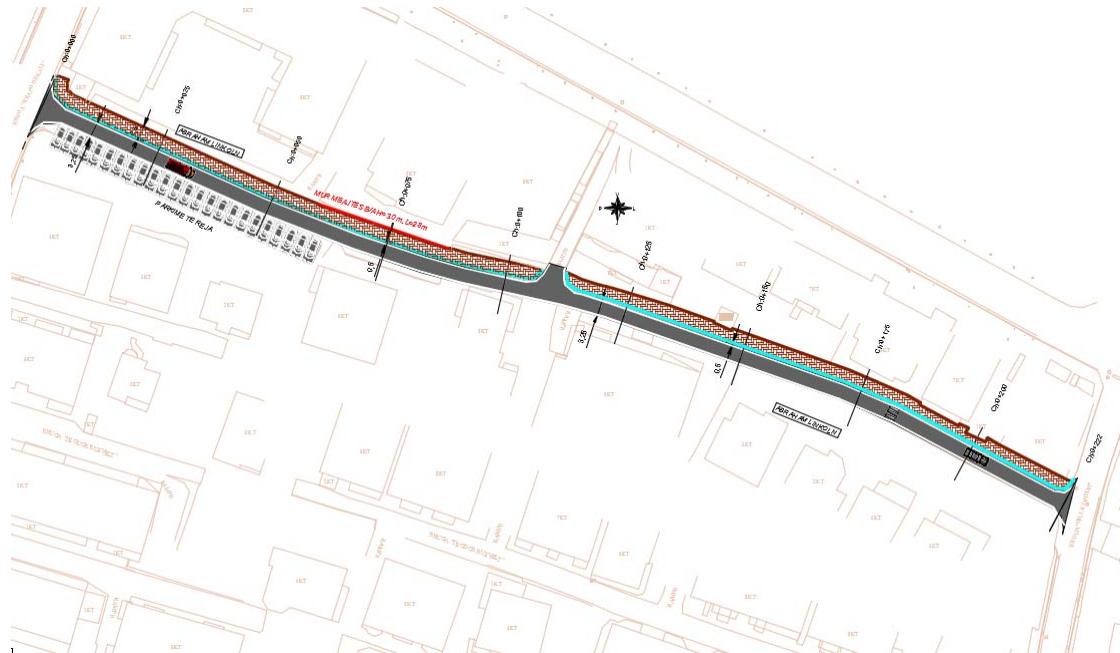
Planimetria e rruges Abraham Lincoln - Blloku Nr.1
